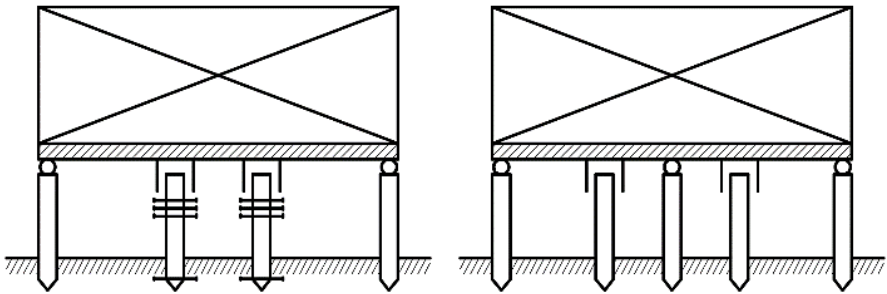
Свайные фундаменты с упругими ограничителями колебаний
